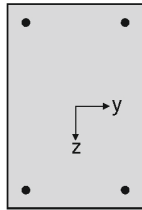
Lage der ersten vier Bewehrungsstäbe
